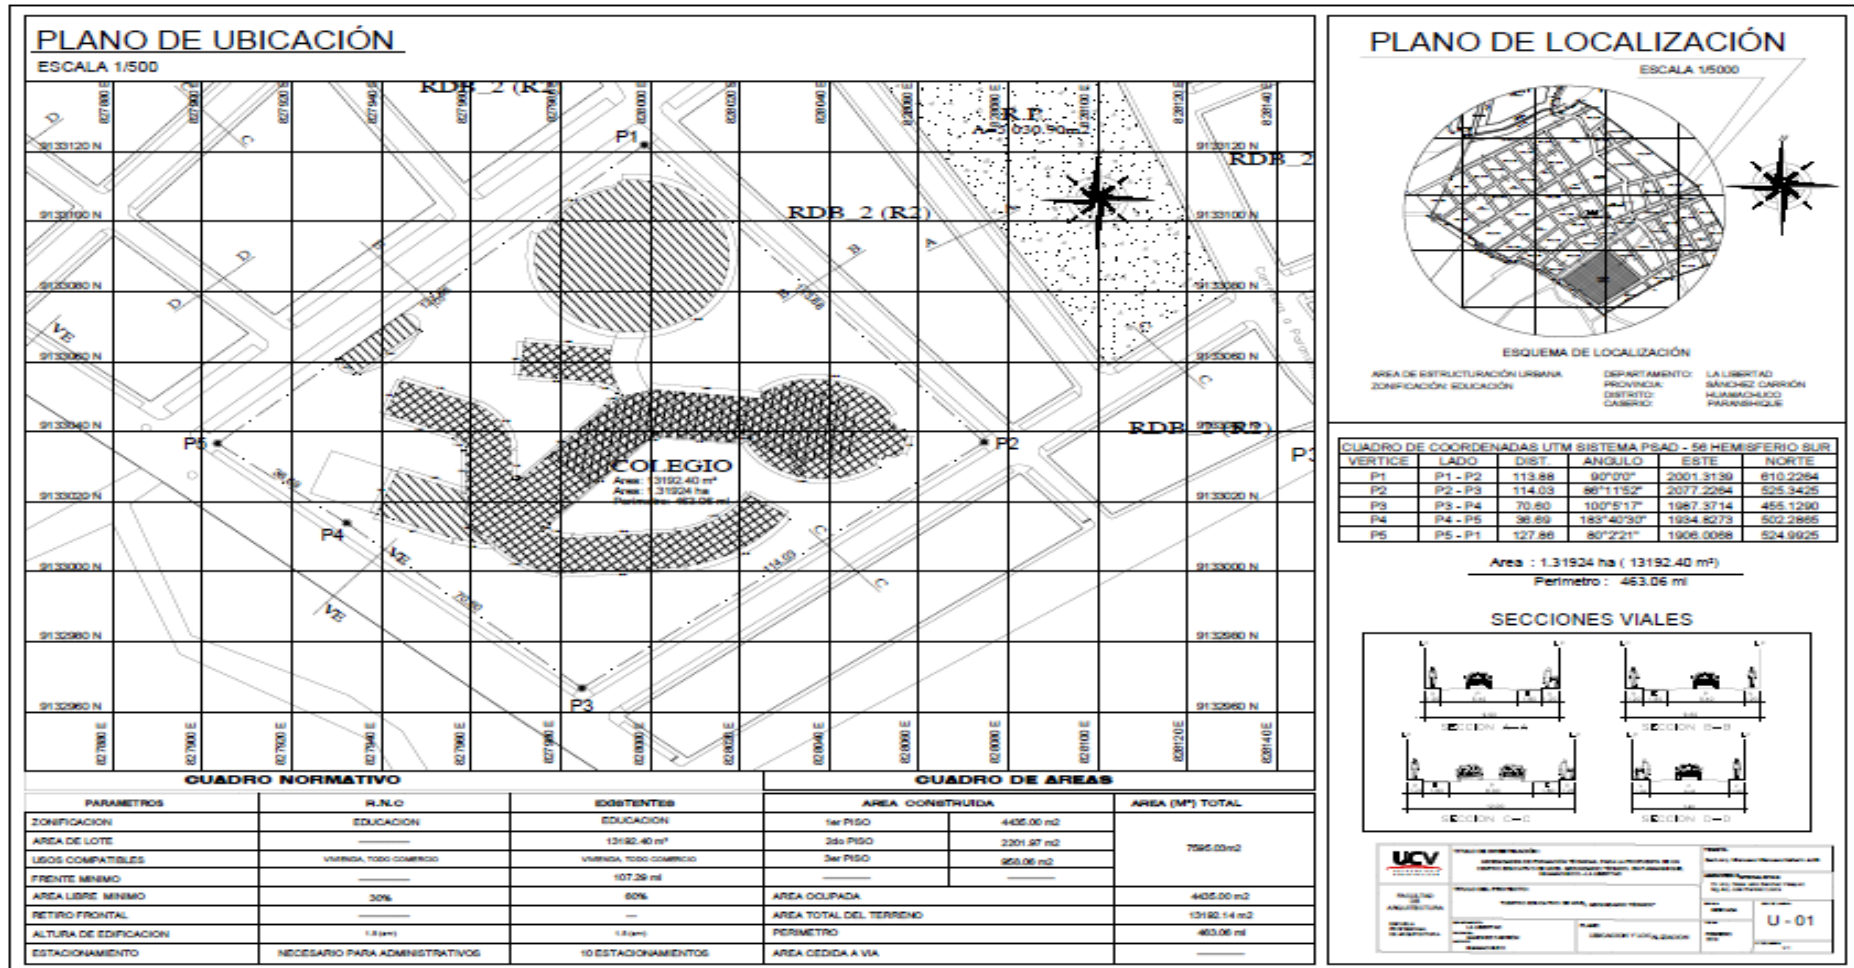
Plano de ubicación y localización – Plano N° 01 - Lamina U-01
